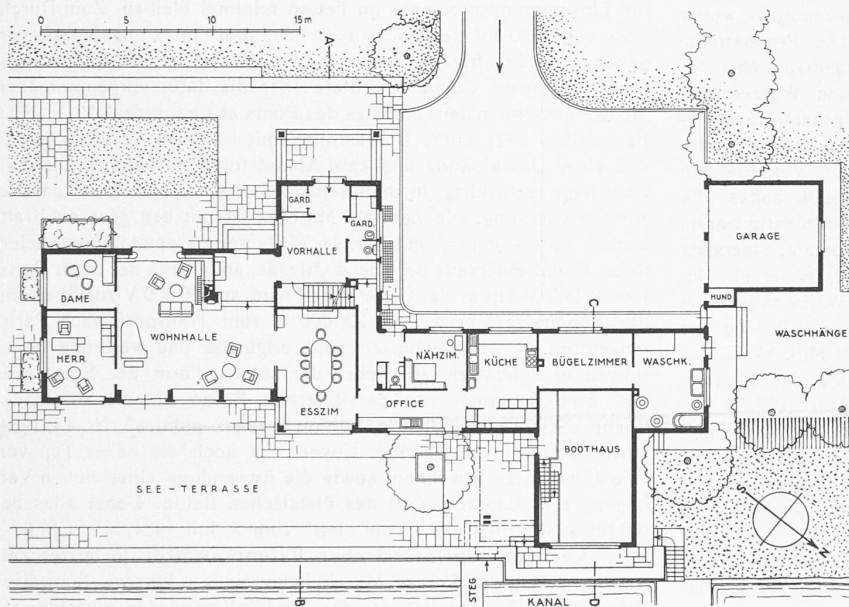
Grundriss vom Erdgeschoss, samt Boothaus und Garage. Vergl. hierzu die Schnitte in Abb. 10 (links nebenan). — Masstab 1 : 400.
